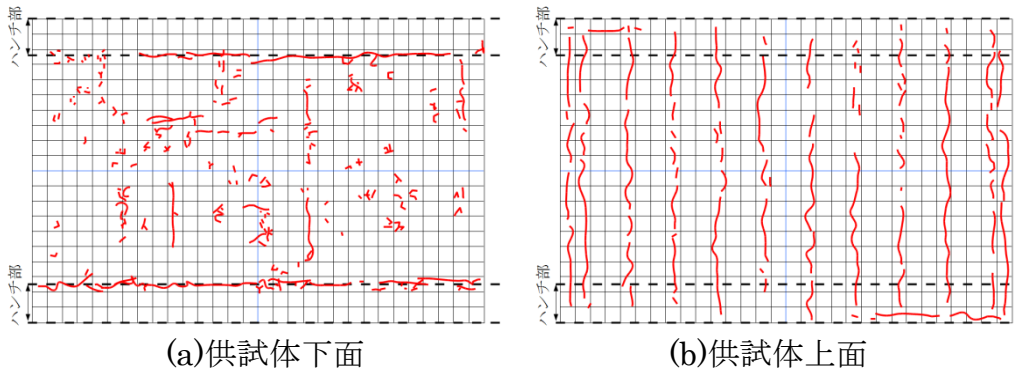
腐食ひび割れ発生状況(浸漬供試体)
